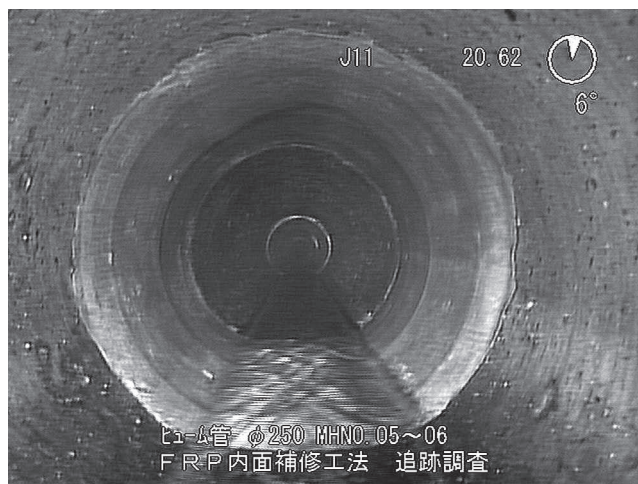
宮城県 平成17年度施工 ϕ 250mm本管（経年6年）
